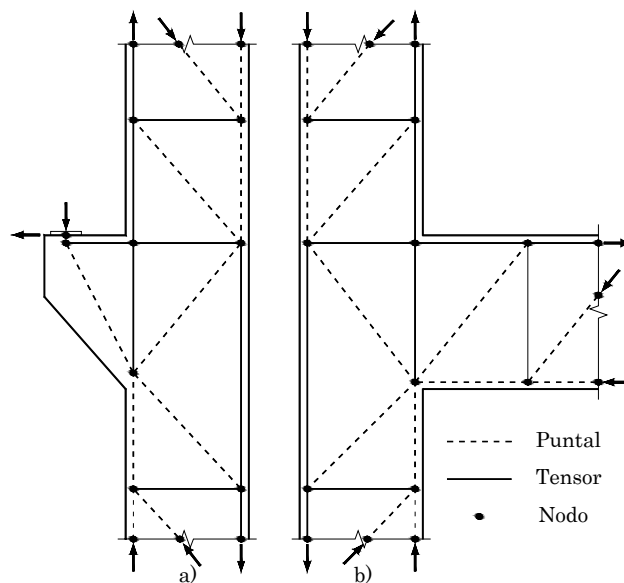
a) Ménsula de apoyo, b) Empotramiento de viga con columna
